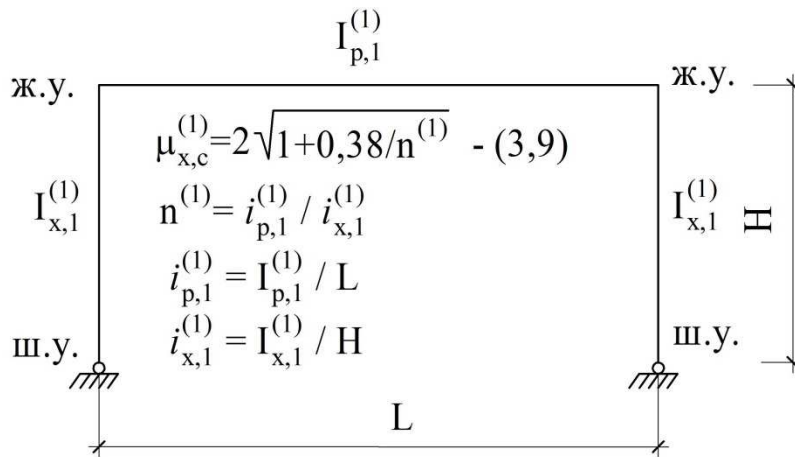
Расчетная схема однопролетной свободной поперечной рамы: верхние узлы - жесткие; нижние - шарнирные; поперечные сечения колонн - постоянное; ригель - эквивалентный стержень
